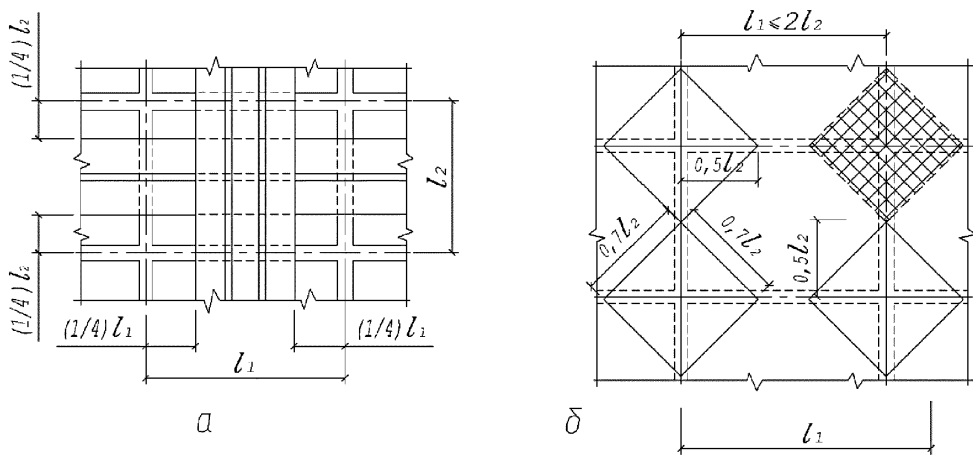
Схема армирования опертой по контуру плиты сварными рулонными сетками:
